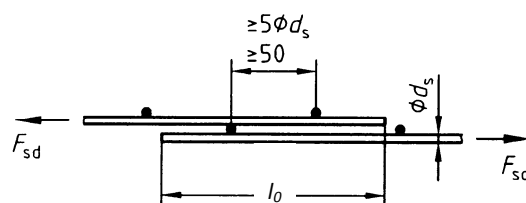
Stoß der Querbewehrung bei Betonstahlmatten
